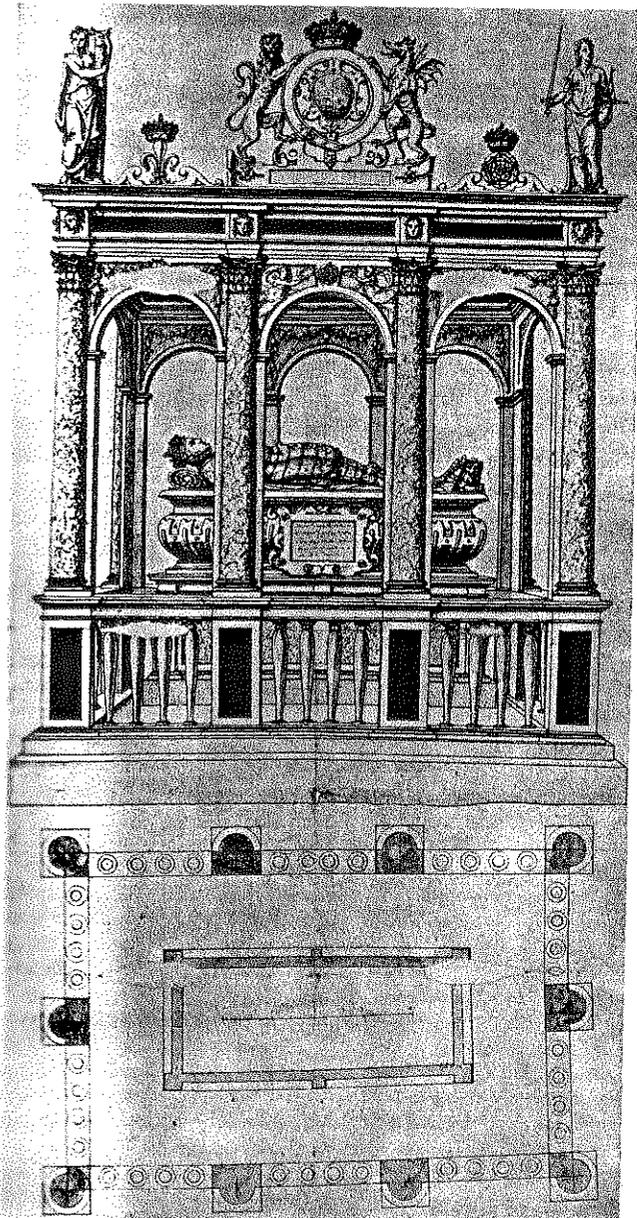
Catedral de Praga. Planta y alzado para una capilla mortuoria.
